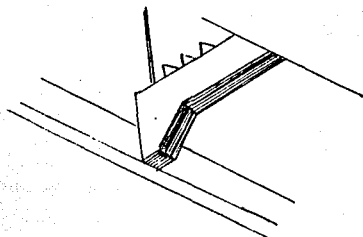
VIGA SECUNDARIA POSTENSADA A UNA VIGA EN VOLADIZO.
